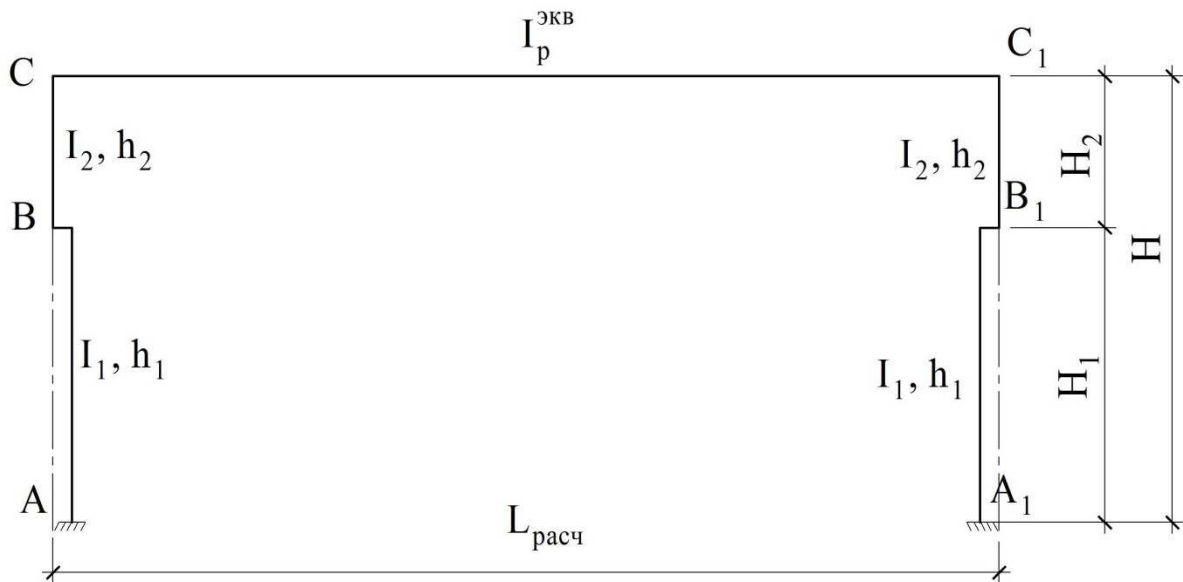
, б – Приближенная расчетная схема поперечной рамы для расчета на ЭВМ или аналитическими методами
